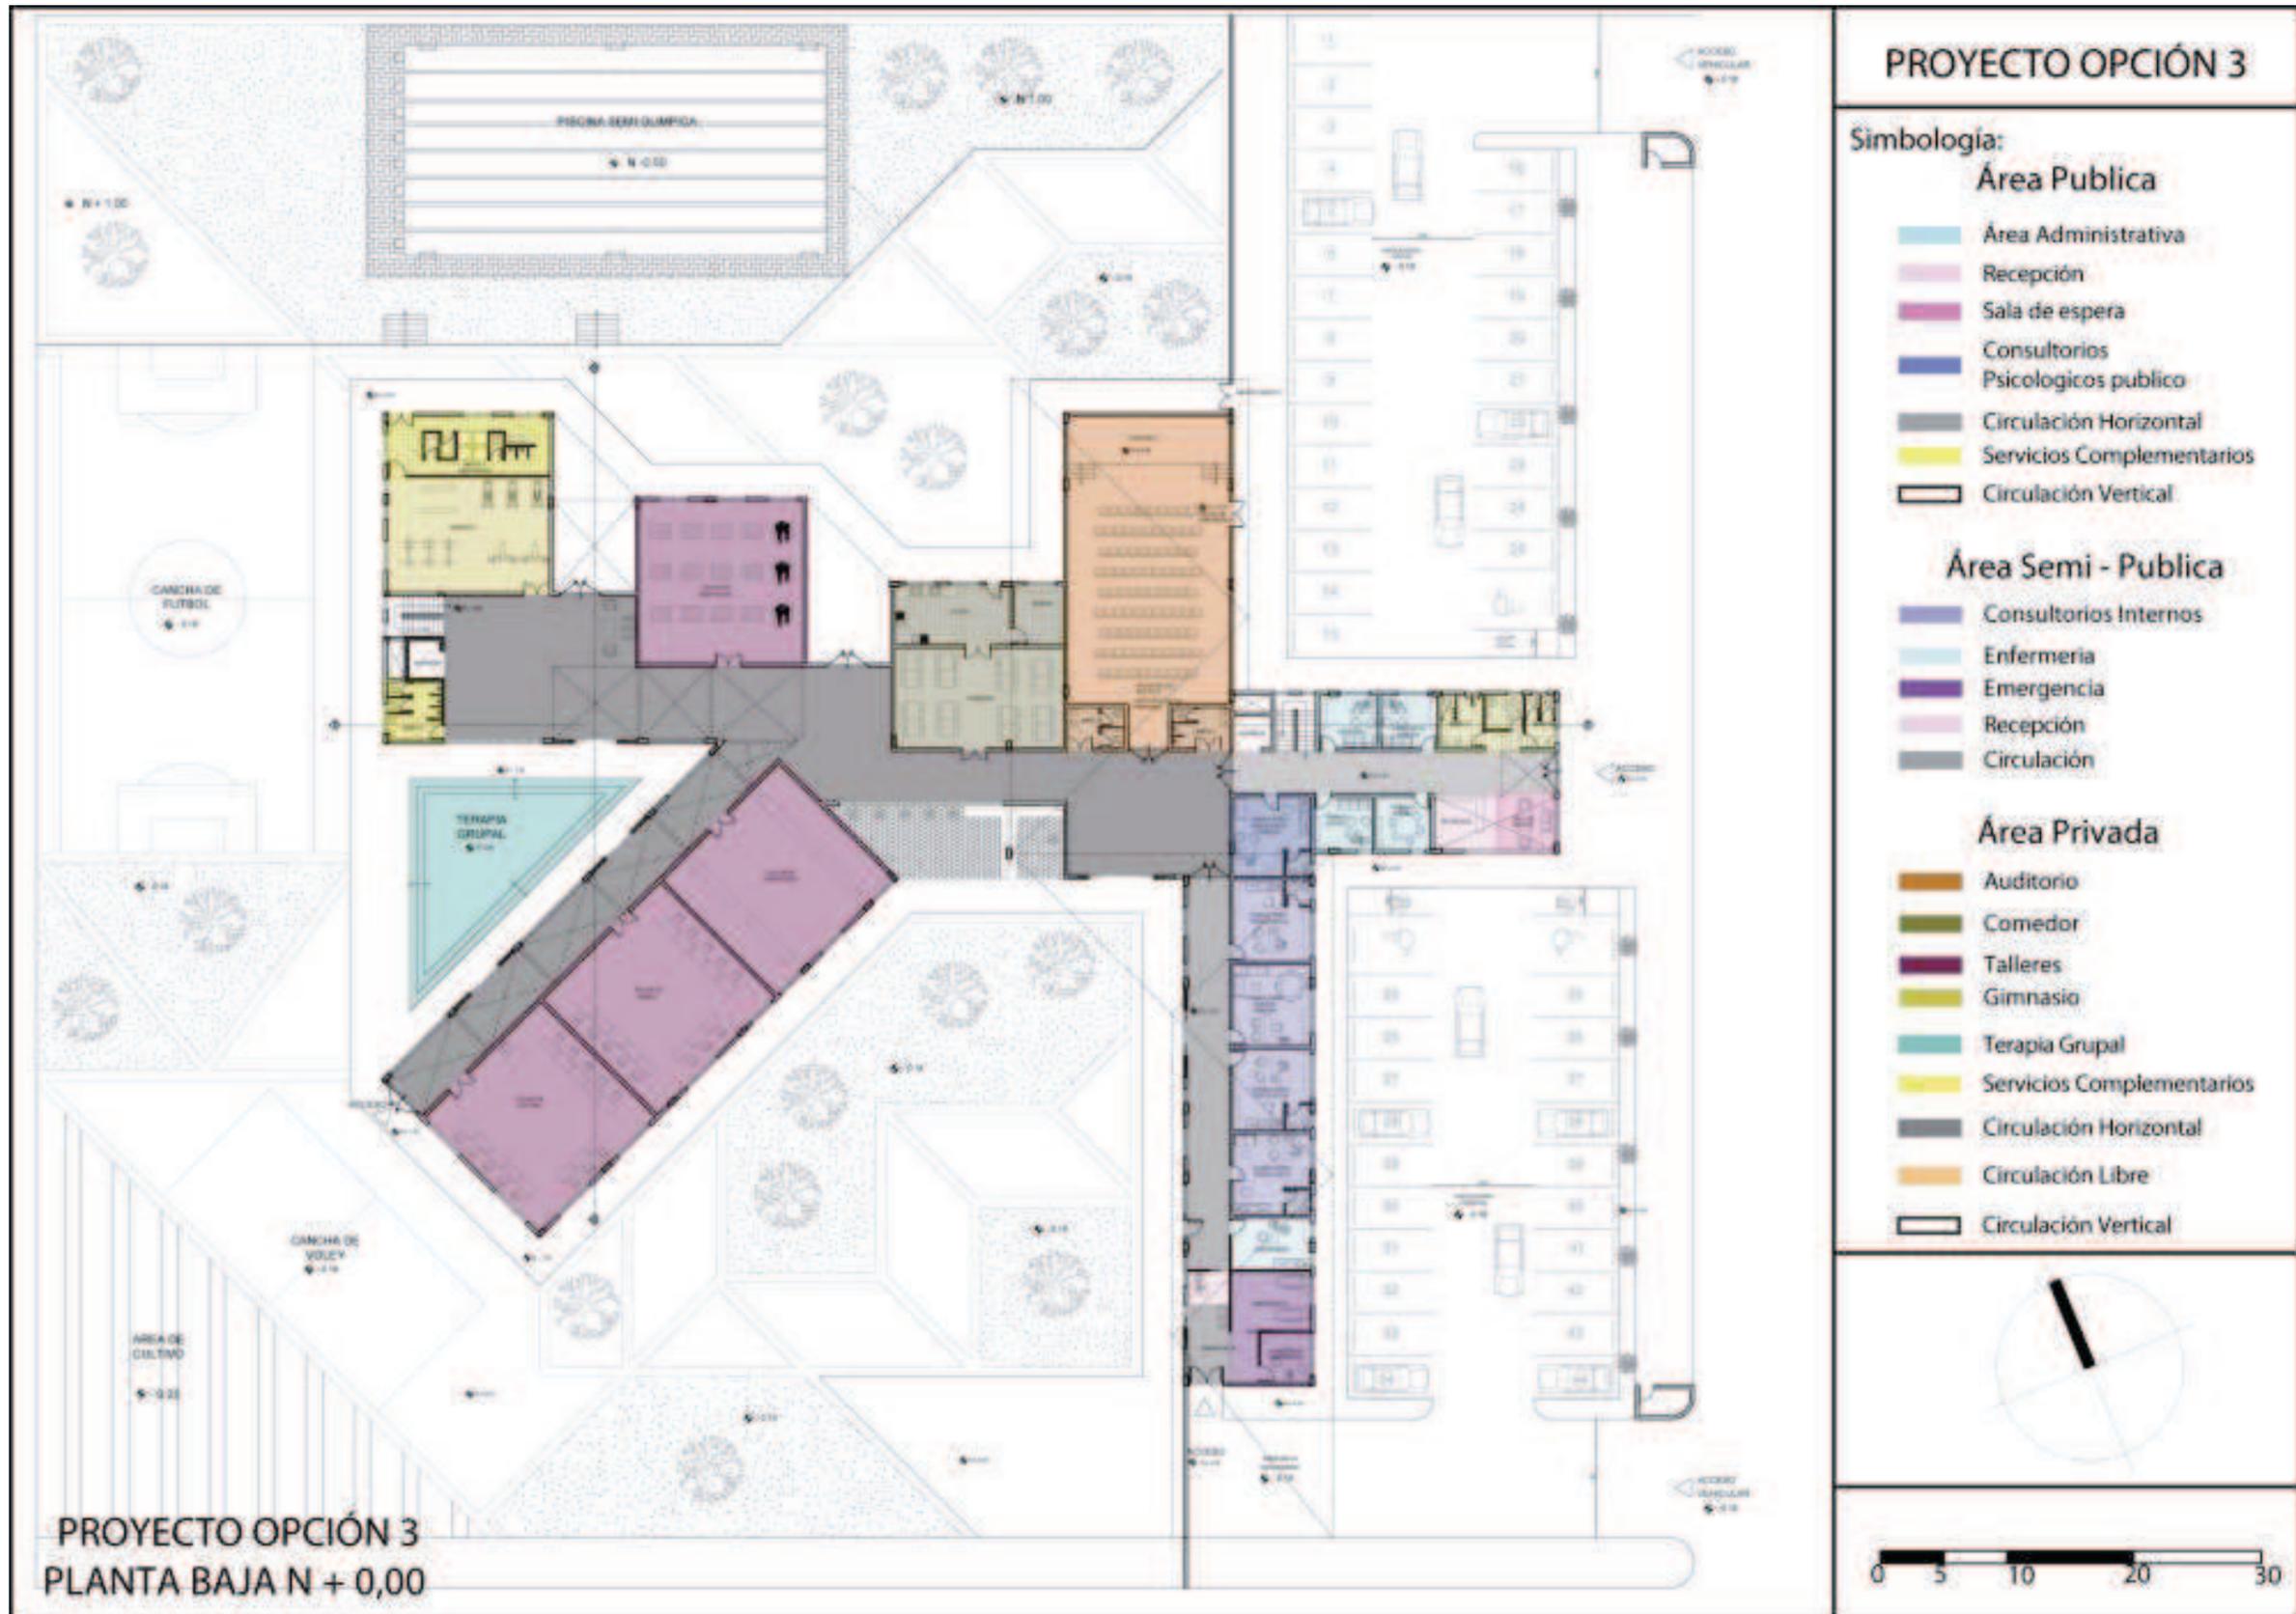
FORMA OPCIÓN 3 PLANTA BAJA Fuente: propia
